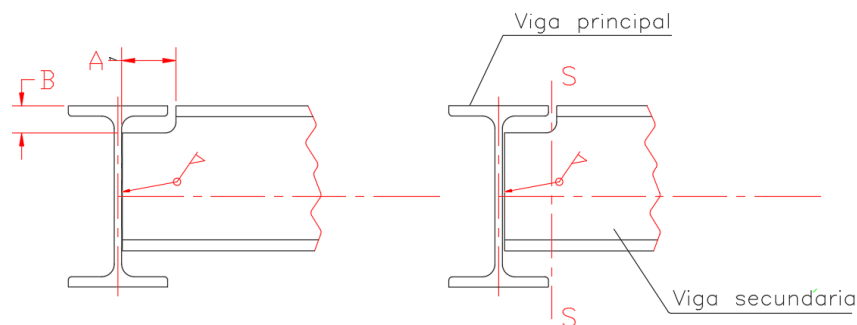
Pormenor de ligação soldada nas vigas do pavimento
